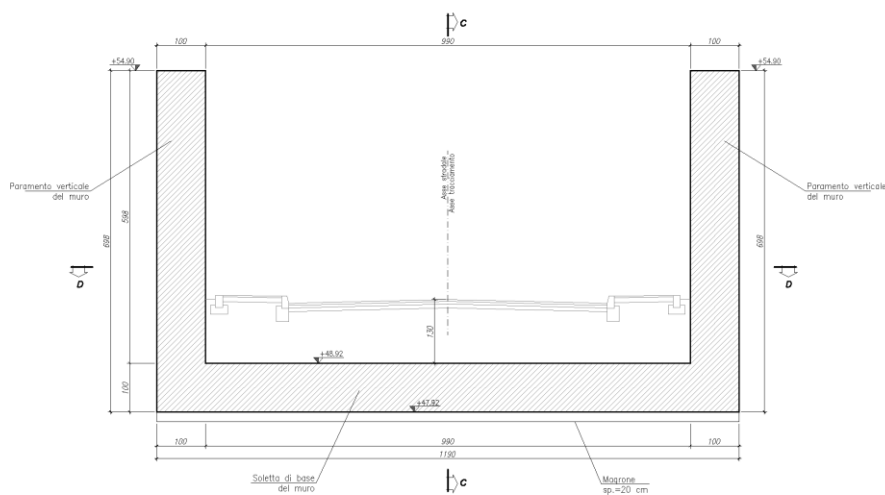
Muro ad “U” lato ovest: Sezione trasversale alla pk 31.90
